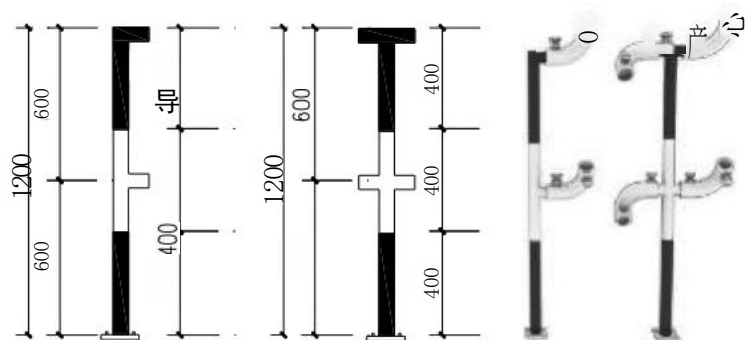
F型、干型防护栏示意图(单位: mm)
